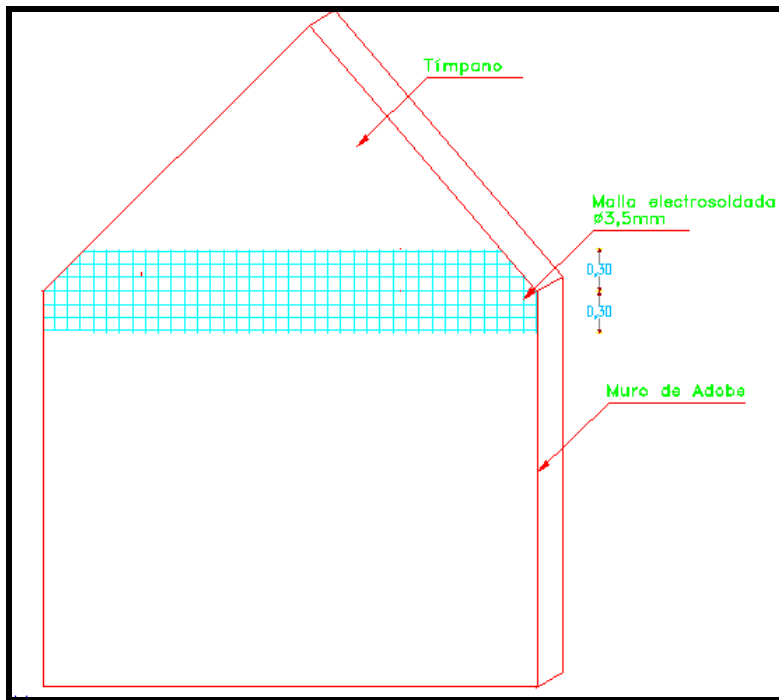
Refuerzo de tímpanos para muros de adobe
